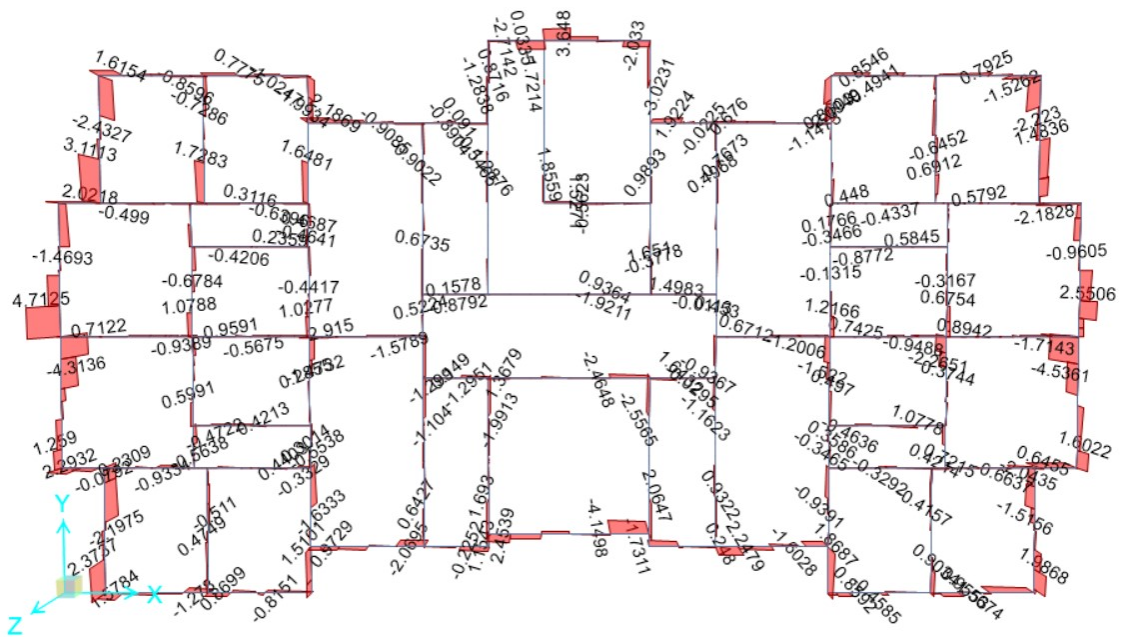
Distribución de acero transversal en vigas de cimentación Sistema Dual - Edificio Blesser. Fuente: Elaboración Propia.
